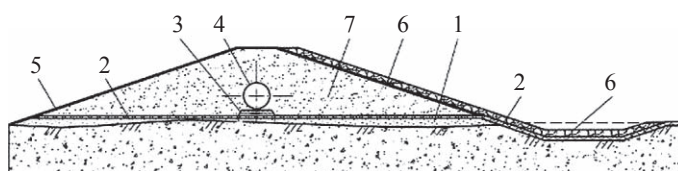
Схема размещения теплоизоляции в основании насыпи наземного участка магистрального газопровода: 1 – выравнивающий слой привозного минерального грунта; 2 – теплоизоляция (жесткая плита); 3 – насыпное грунтовое основание газопровода; 4 – магистральный газопровод; 5 – средства инженерной защиты насыпи; 6 – георешетка; 7 – насыпь
